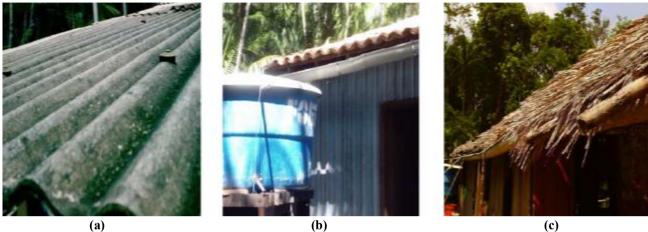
Tipos de telhados estudados: (a) telhado de fibrocimento; (b) telhado de cerâmico; (c) telhado de palha
